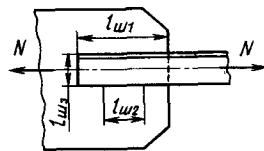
Схема к расчету соединительных швов крепления уголка
